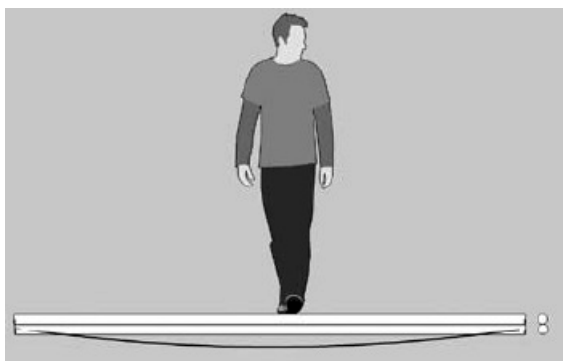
Изгиб гуадуа с двумя вертикальными стержнями
